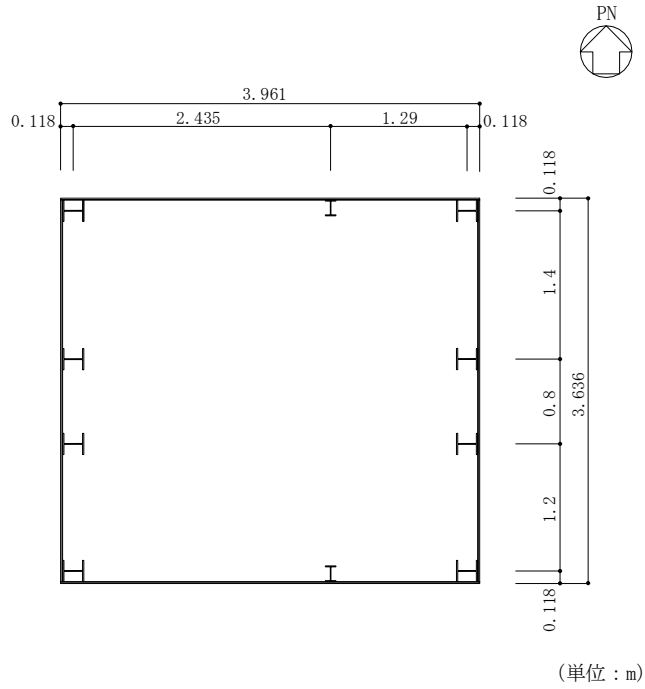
燃料移送ポンプエリア竜巻防護対策設備の平面図
